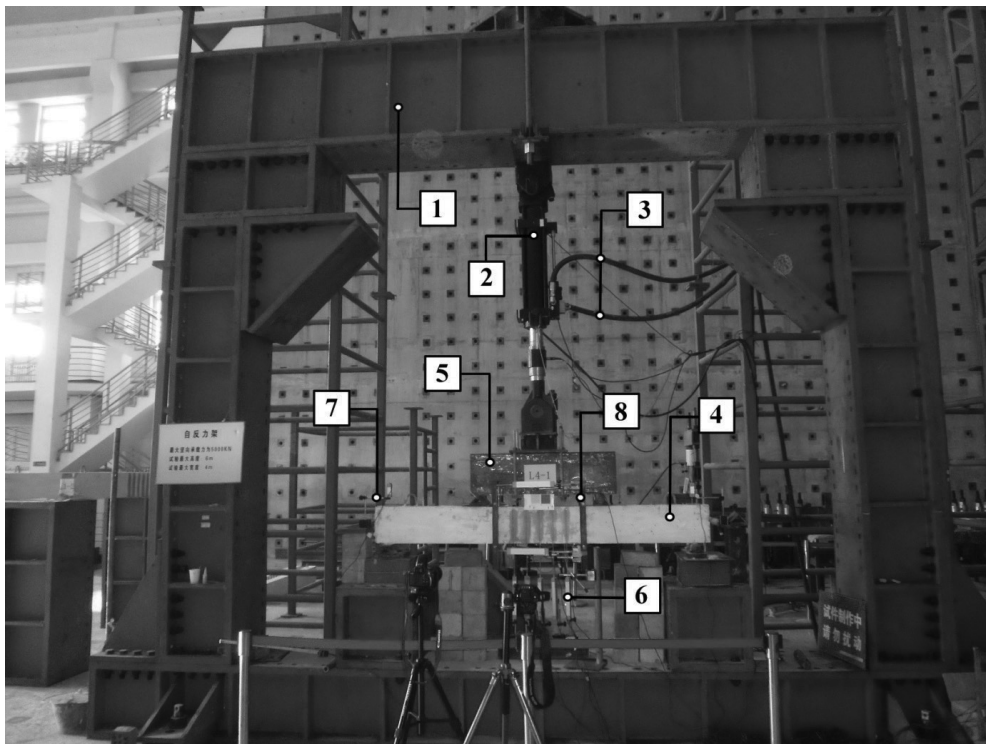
Общий вид испытательной установки и схема расположения приборов:
